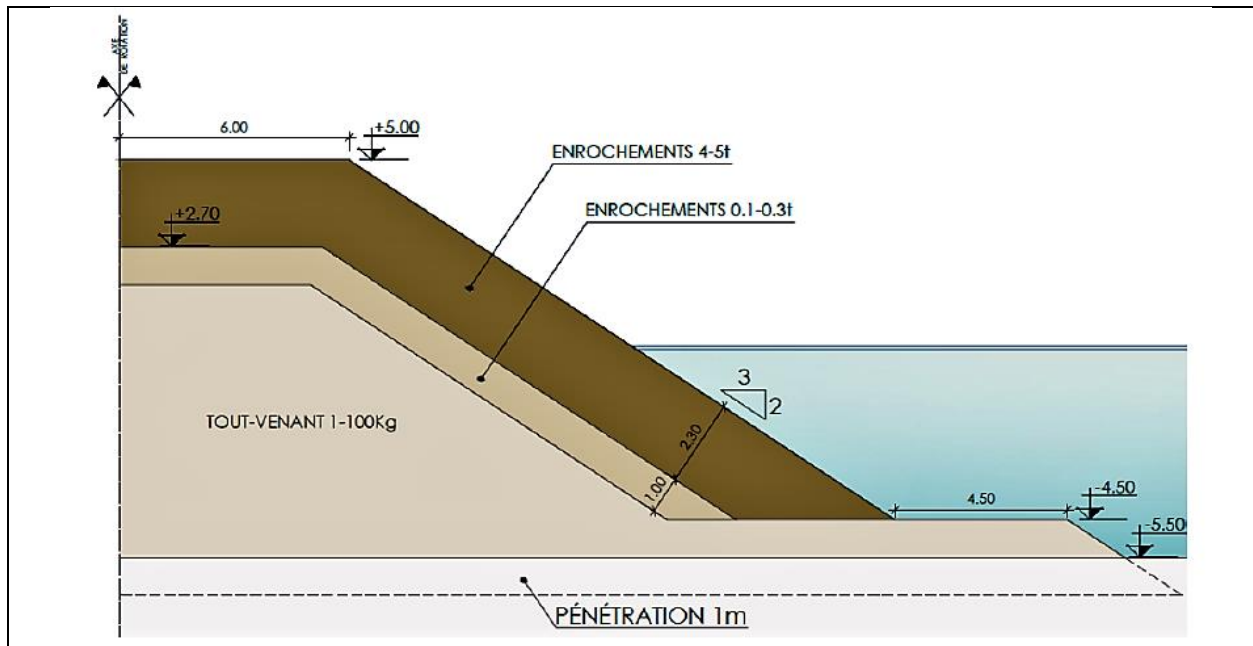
Coupe type du musoir de la jetée secondaire. (BTP Infrastructuras)
